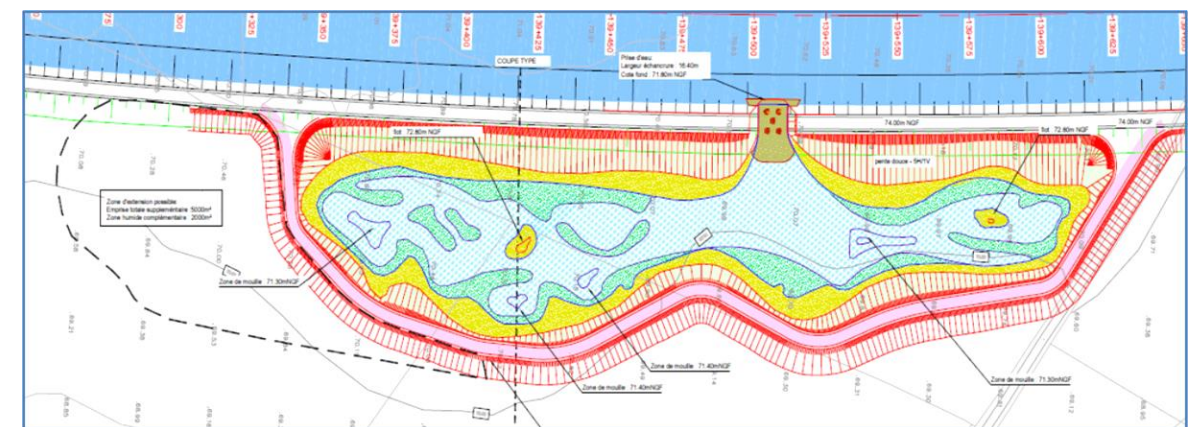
Vue en plan de l'annexe hydraulique au PK139,5 (Source : ONE, 2021)
